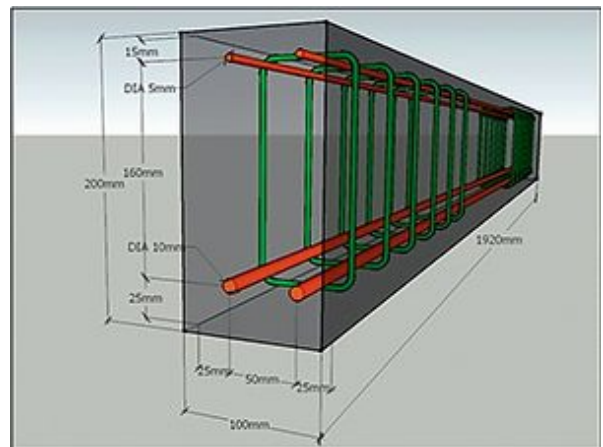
Posicionamento da armadura e dimensões finais da viga
